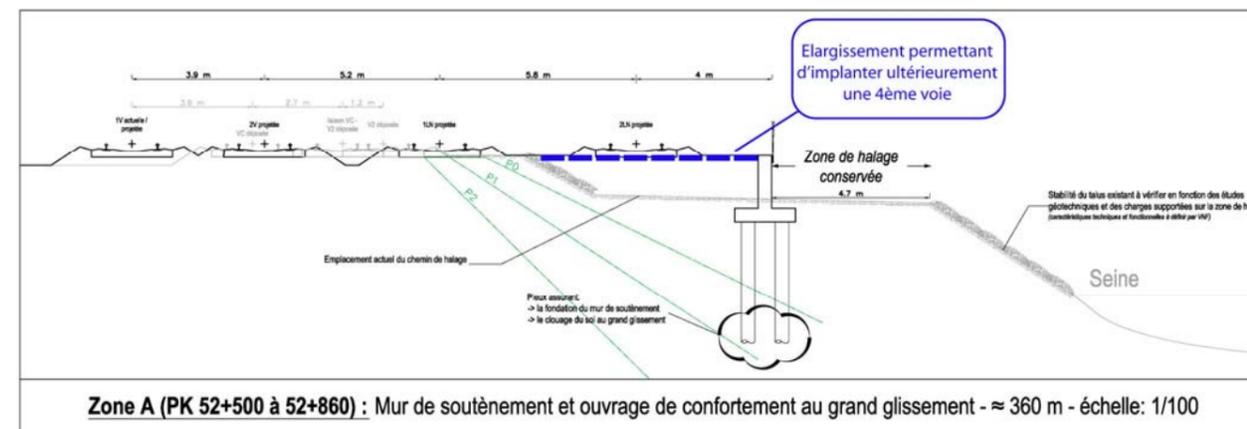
Coupe transversale, montrant l'élargissement s'appuyant sur un mur de soutènement
